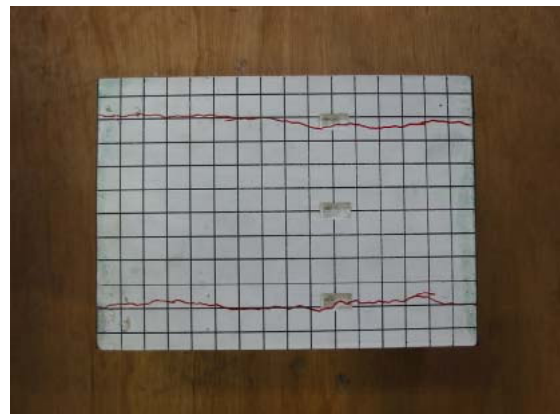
ひび割れ状況 (主函体左側壁外面)
